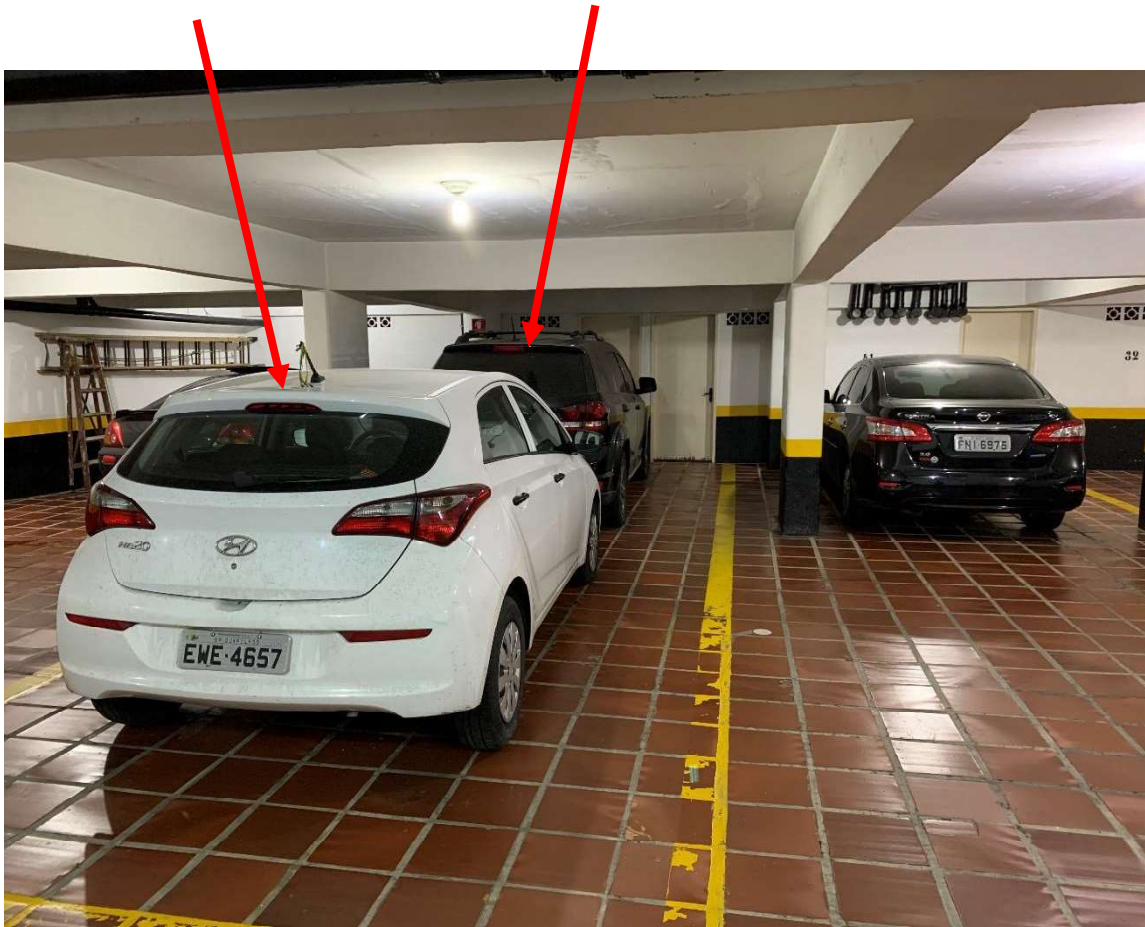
Vista do depósito privativo em frente as 02 vagas de garagem do apto nº 42, no 1º subsolo do edifício.
